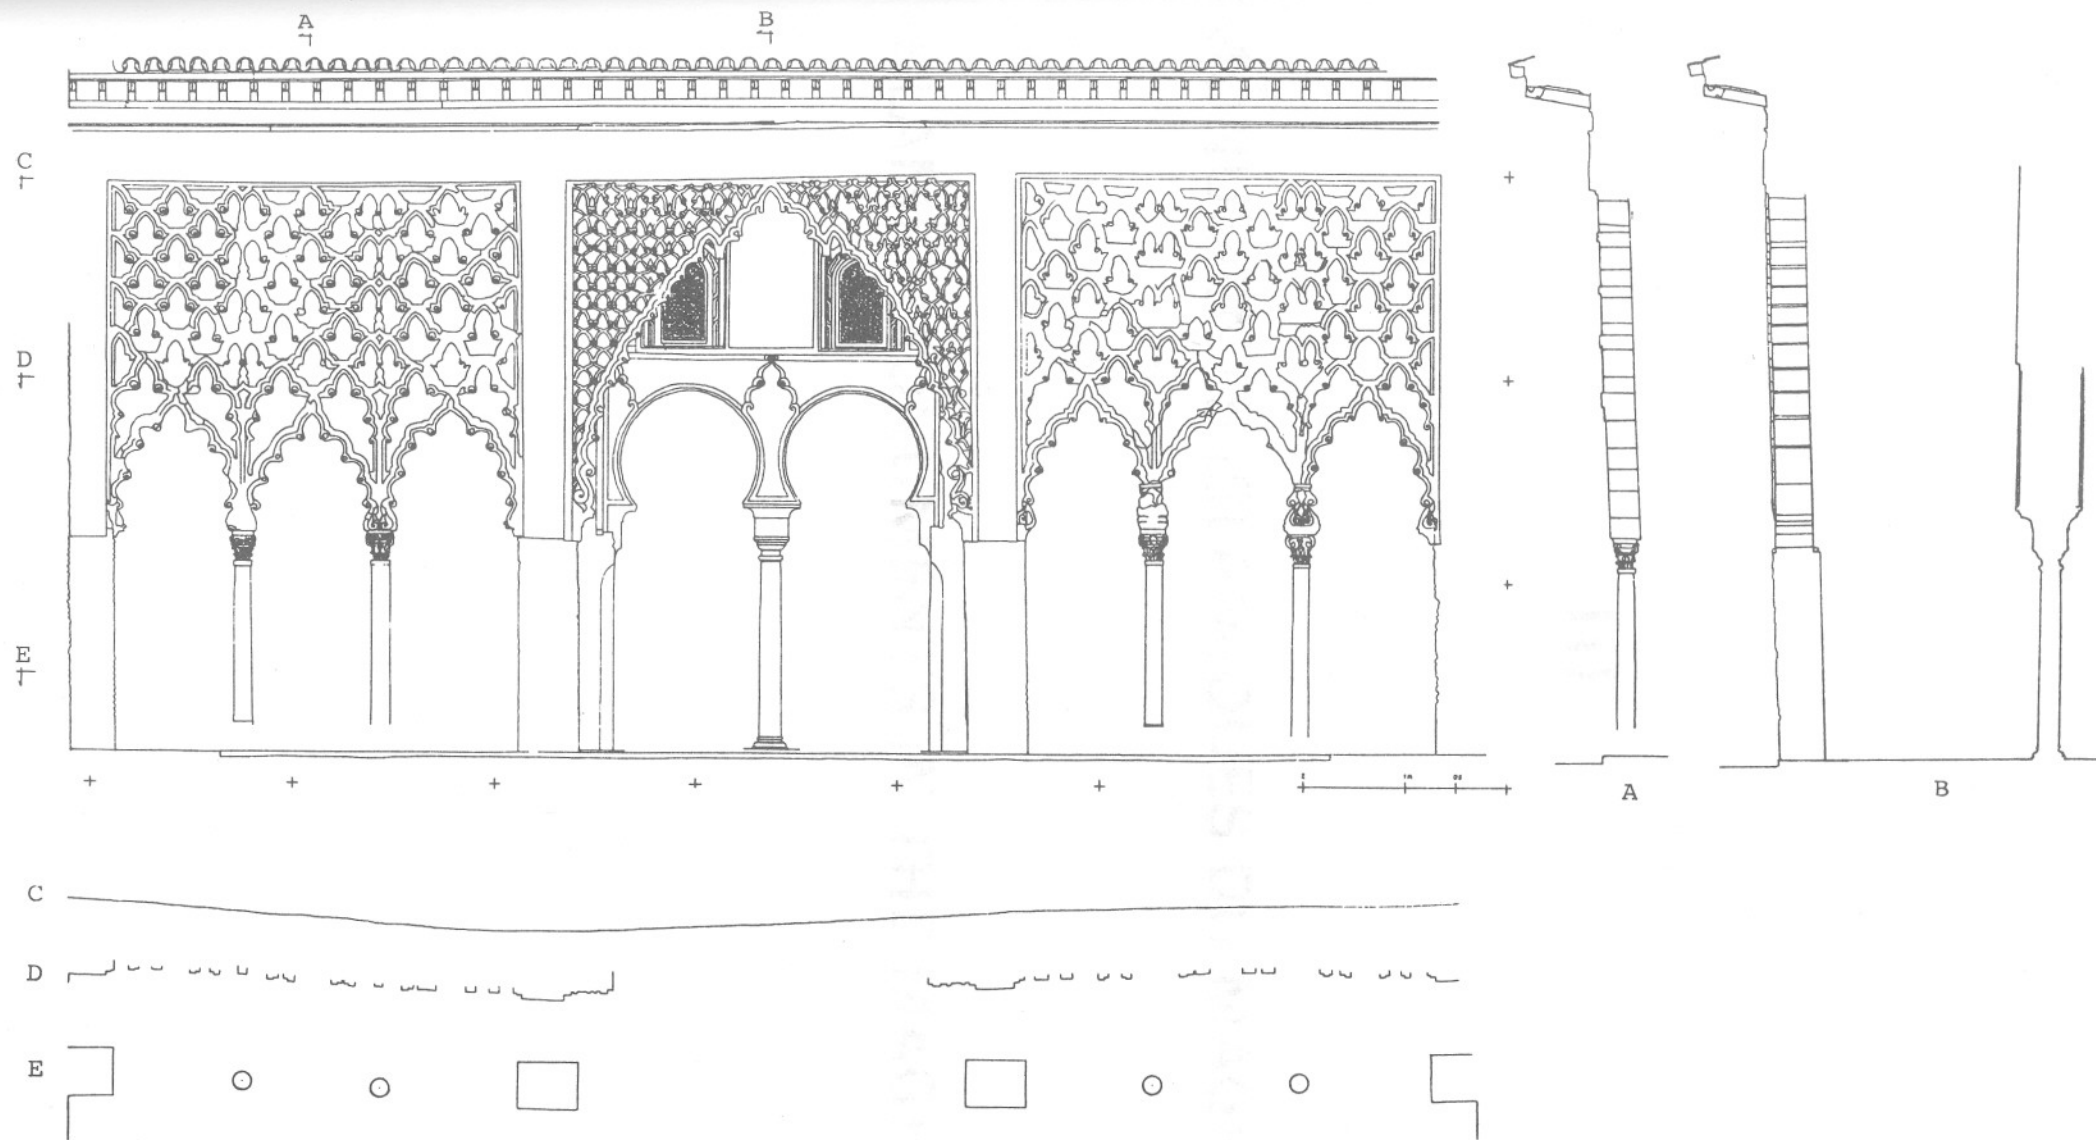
Séville, Alcazar, Patio del Yeso. Relevé photogrammétrique d'une face, en élévation, plan et coupes. Echelle originale 1:25.
